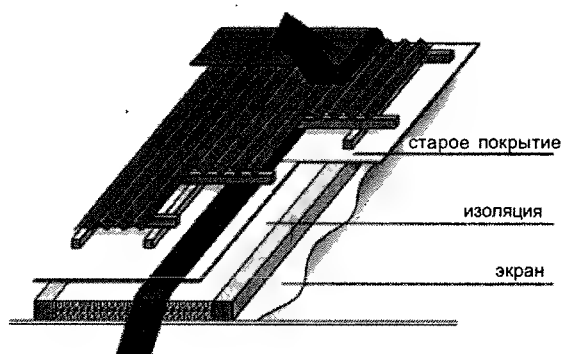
Монтаж битумного гофрлиста по старой кровле
